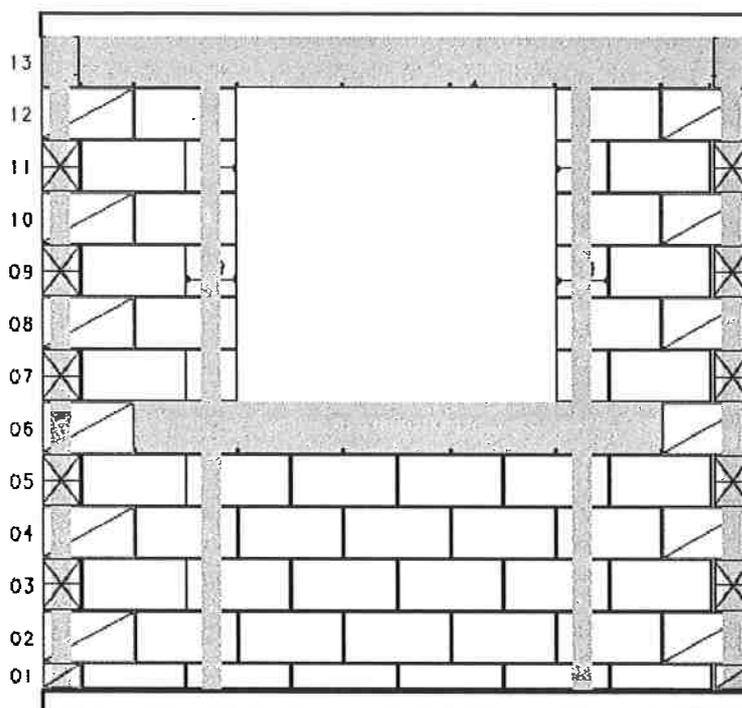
Estrutura de uma parede de alvenaria estrutural
